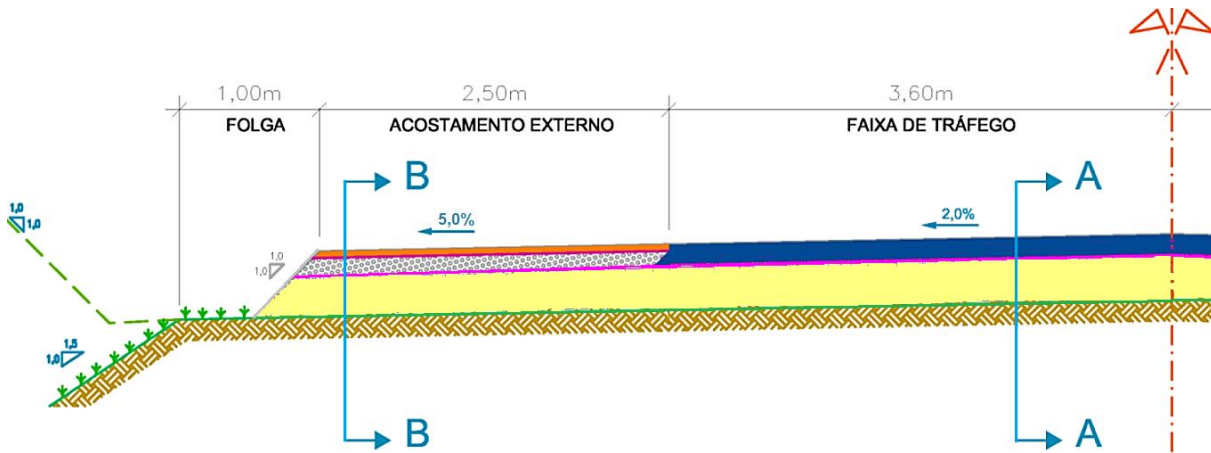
Seção tipo rodovia (restaurações) para levantamento de custos
